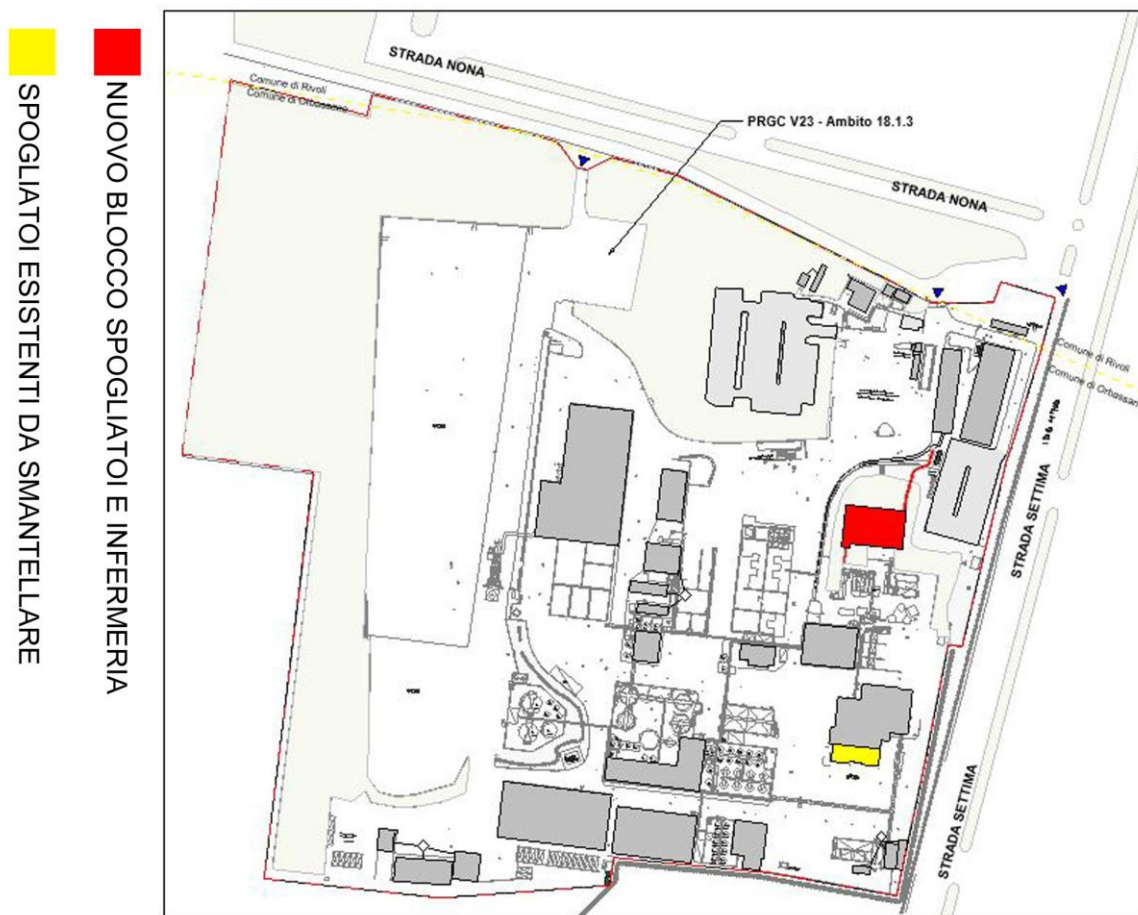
Planimetria generale dell'impianto con ubicazione spogliatoi
